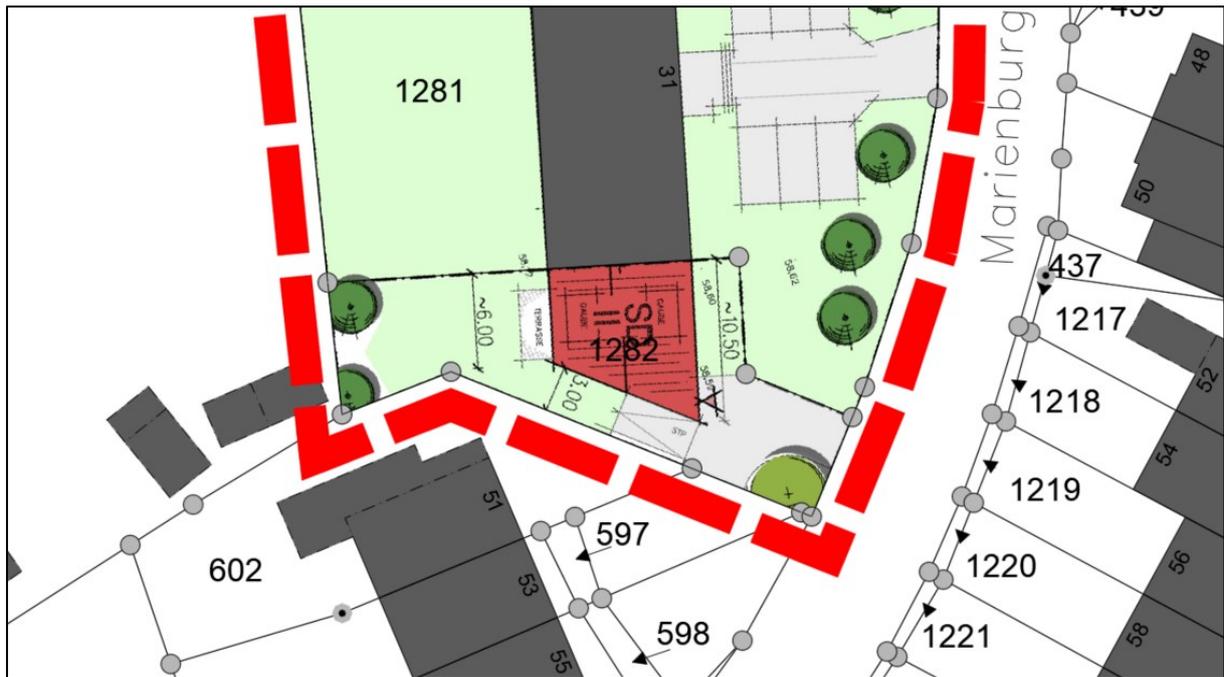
geplante südliche Bebauung (Projektplanung vom 05.01.2022)
